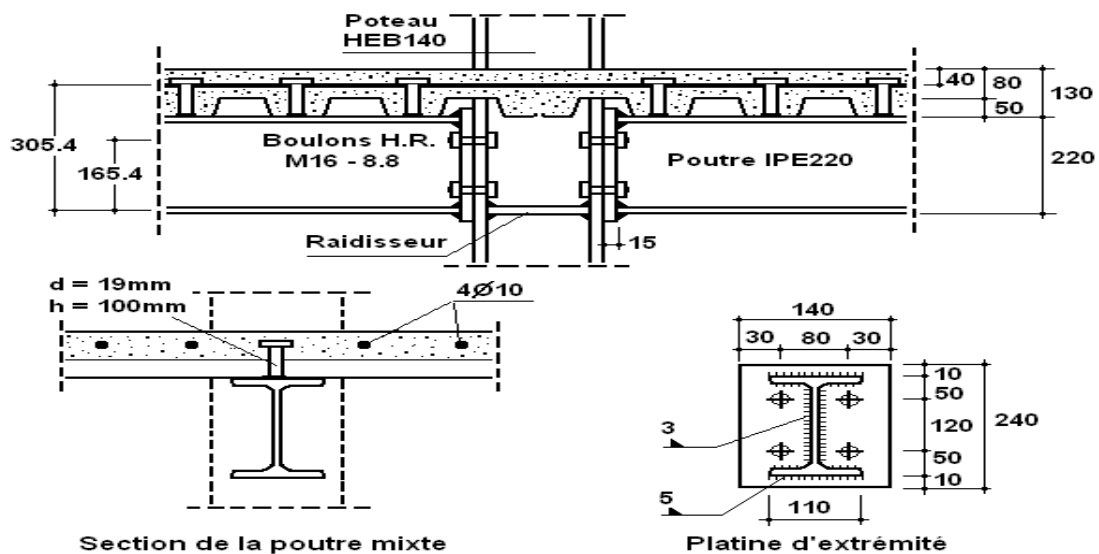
Assemblage mixte poutre-poteau par platine d'extrémité.
